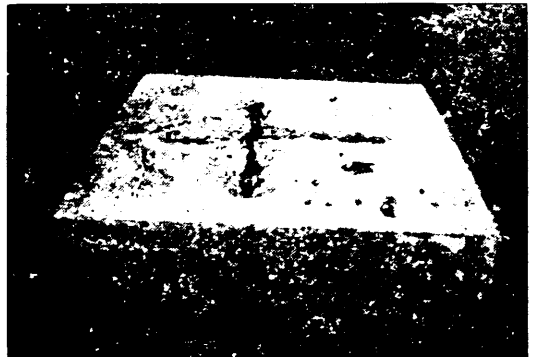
コンクリート(A)の掘削試験後の状況 (試料 No. 11)
